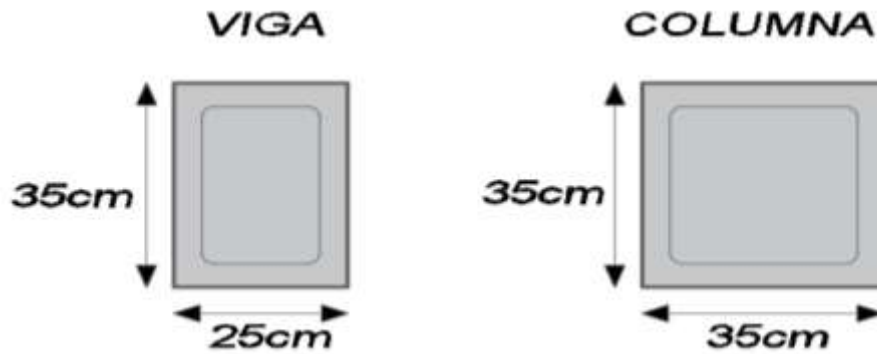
Dimensiones preliminares del elemento viga y elemento columna
